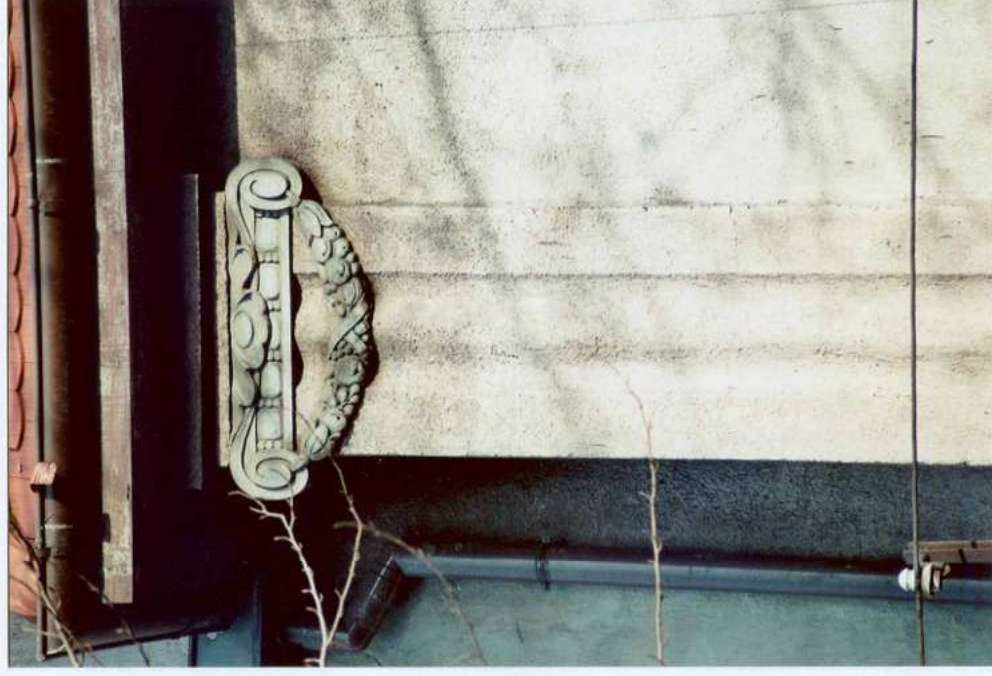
Elewacja zachodnia, skrzydło północne – wysunięcie części elewacji
